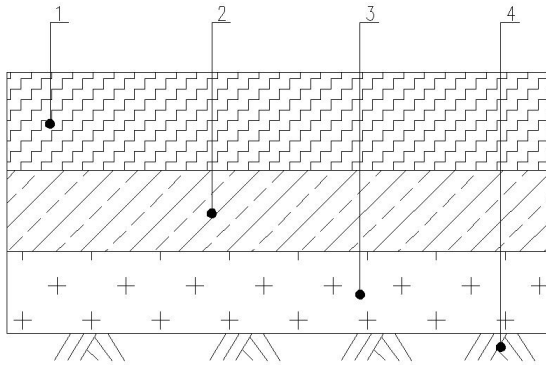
半透式透水水泥混凝土路面结构示意图
